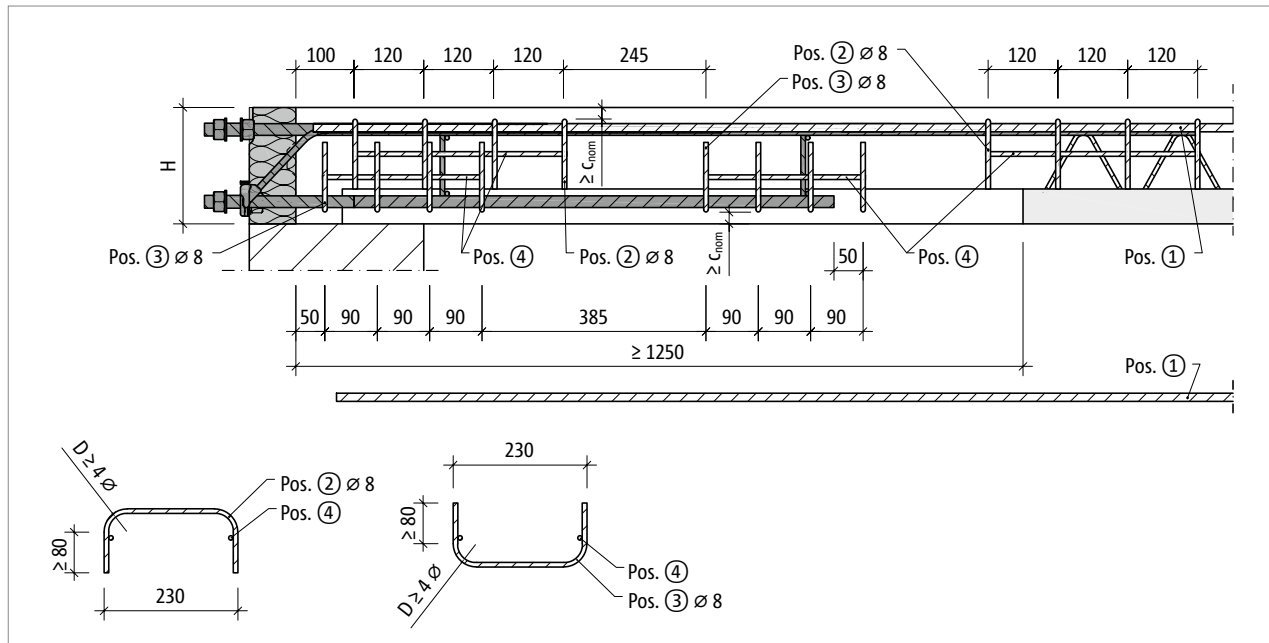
Schöck Isokorb® T type SK-MM2 : renforcement sur site pour mode de construction semi-préfabriqué avec étriers $\varnothing 8$ mm ; coupe
